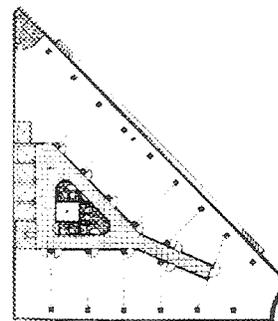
Edifício sede do banco da Lavoura, Vital Brazil, Belo Horizonte. Planta do andar-tipo.
